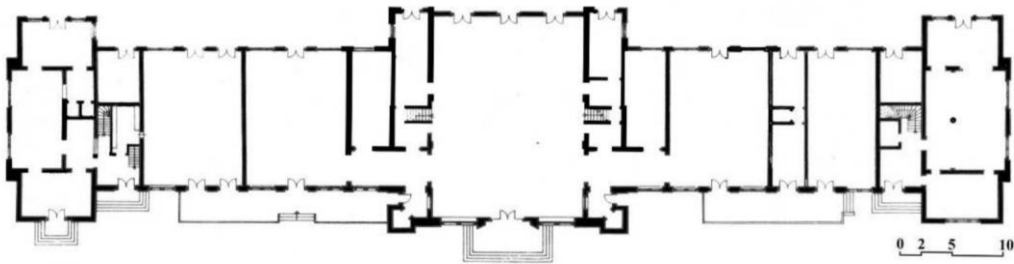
Eski Gar Binası Zemin Kat Planı (M.Yavuz,2005)
